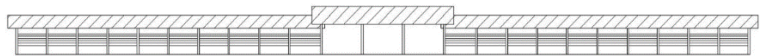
Planta Baixa da Escola Tancredo de Almeida Neves⁸
